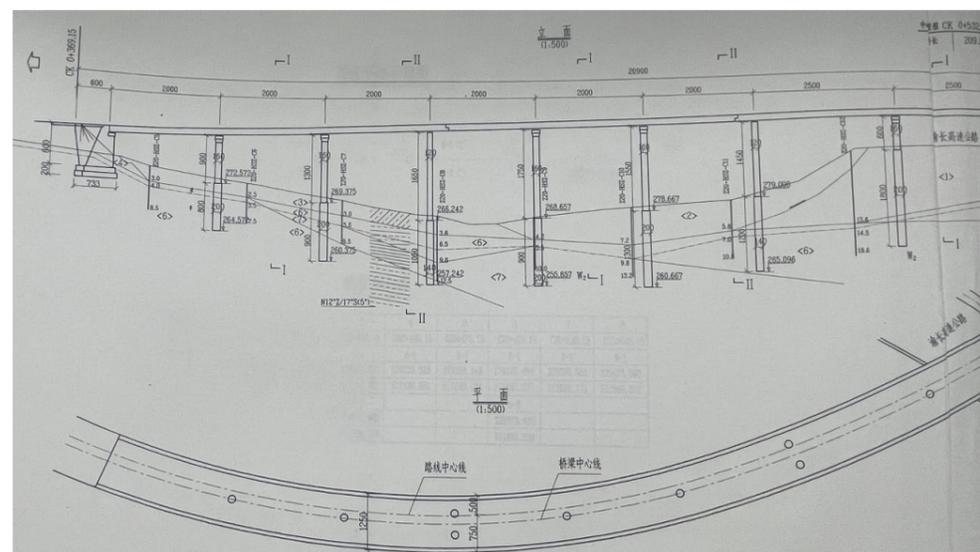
黑石子 C1 匝道桥立面图和平面图 (单位: cm)
